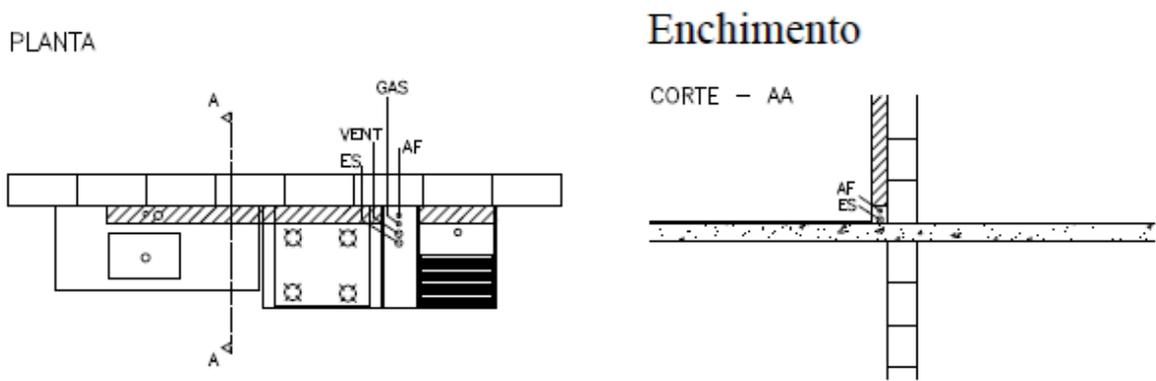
Parede enchimento – para passagem da tubulação
